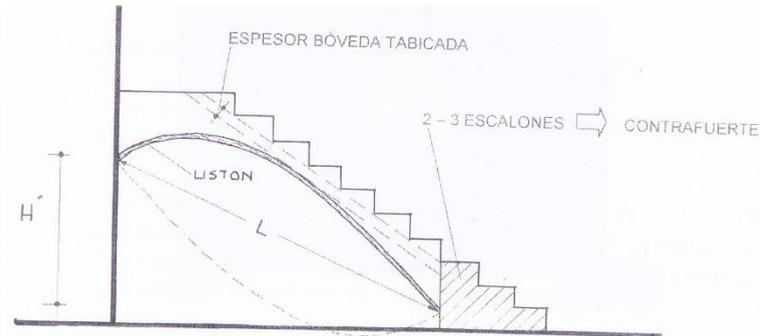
Detalle escalera bóveda tabicada. Fuente: Apuntes Construcción I UPV
